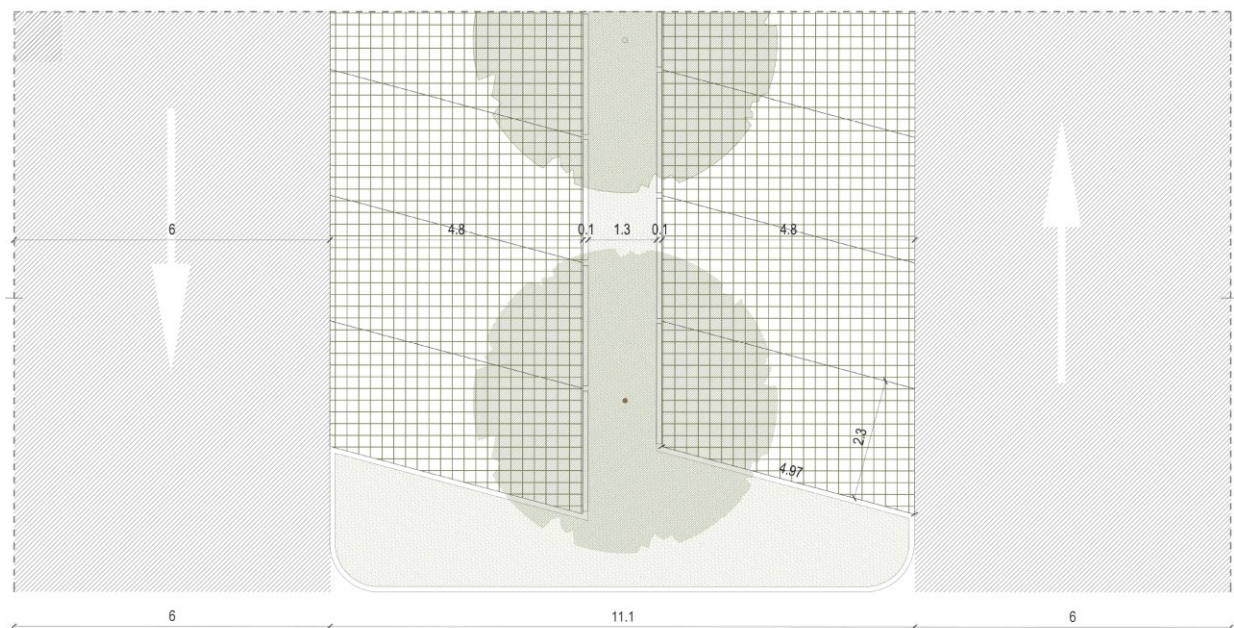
Stralcio pianta tipo parcheggi in progetto.
